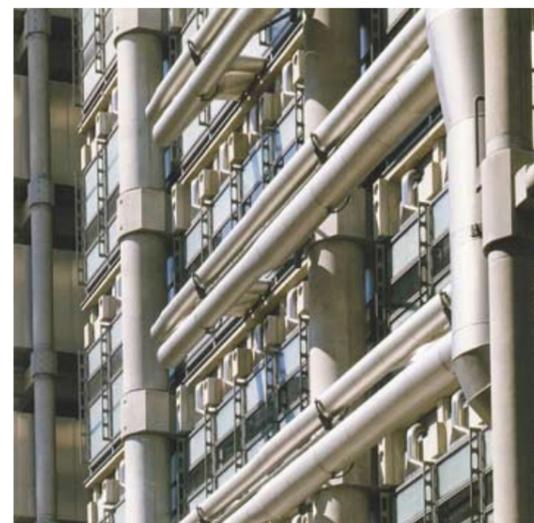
Lloyd's of London 1986 Aire acondicionado por fachada.
